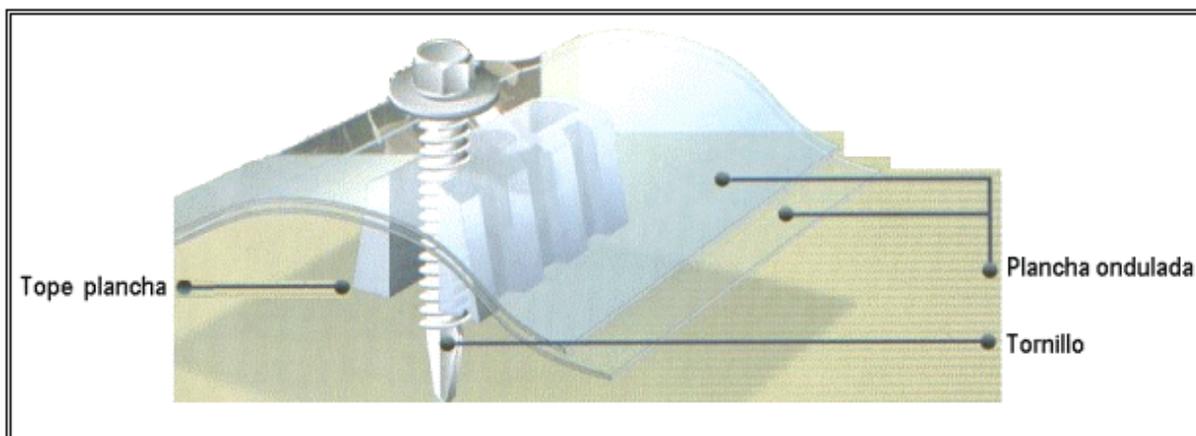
Fijación de placas onduladas utilizando un tope distanciador.
